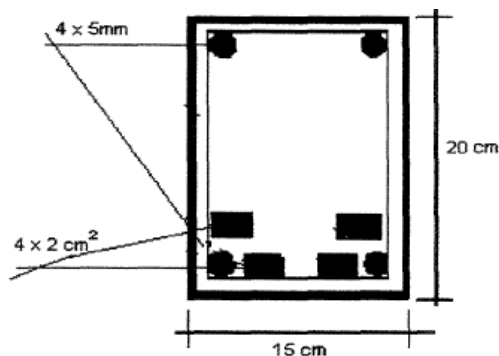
Posicionamento de armadura na viga 3 ensaiada.
